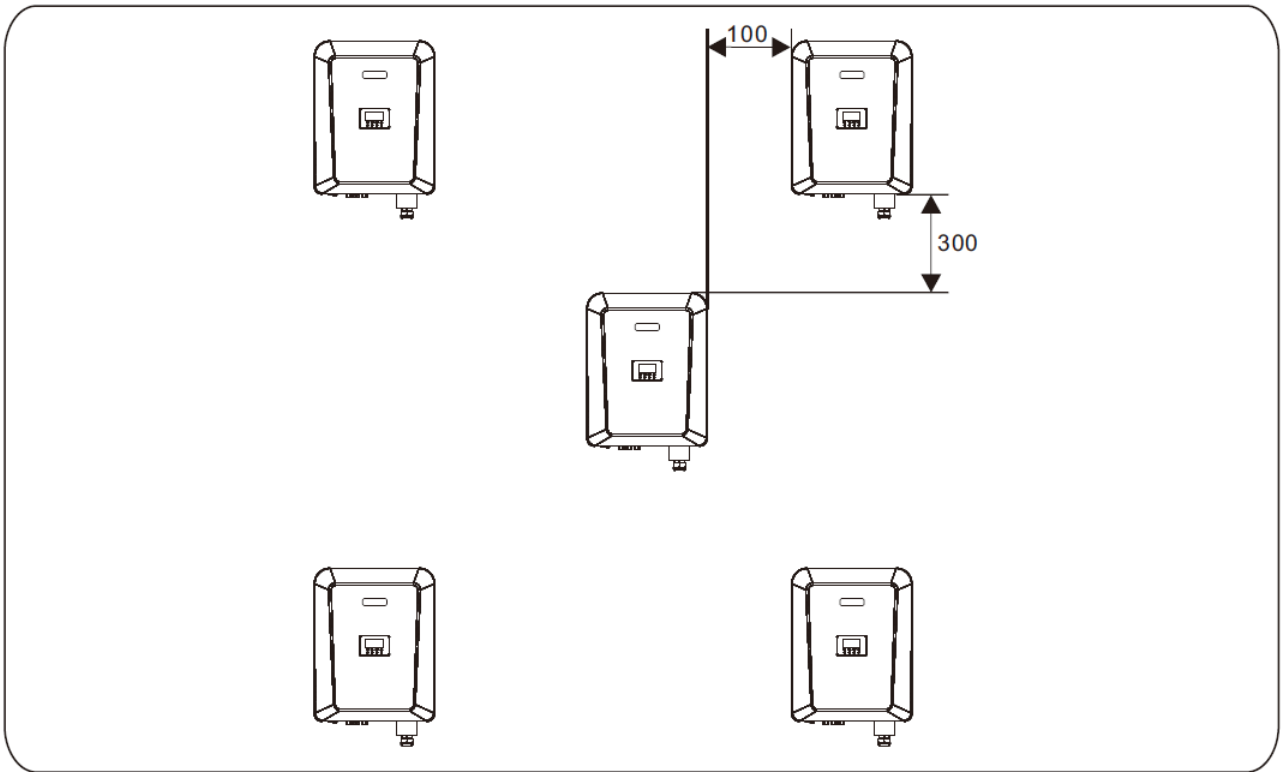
Installazione in modalità triangolo (unità: mm)
